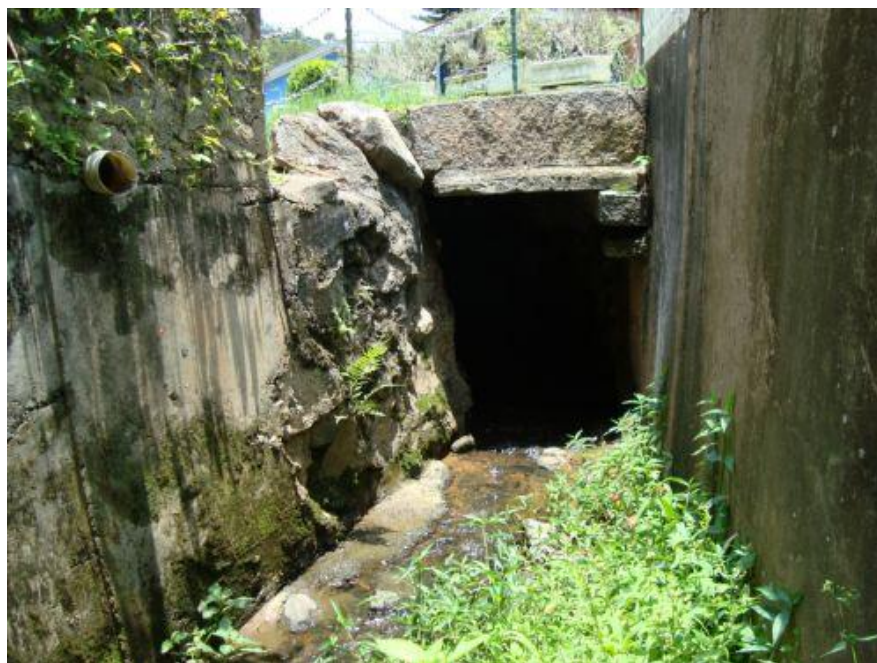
Entrada de galeria trapezoidal em terreno residencial.
